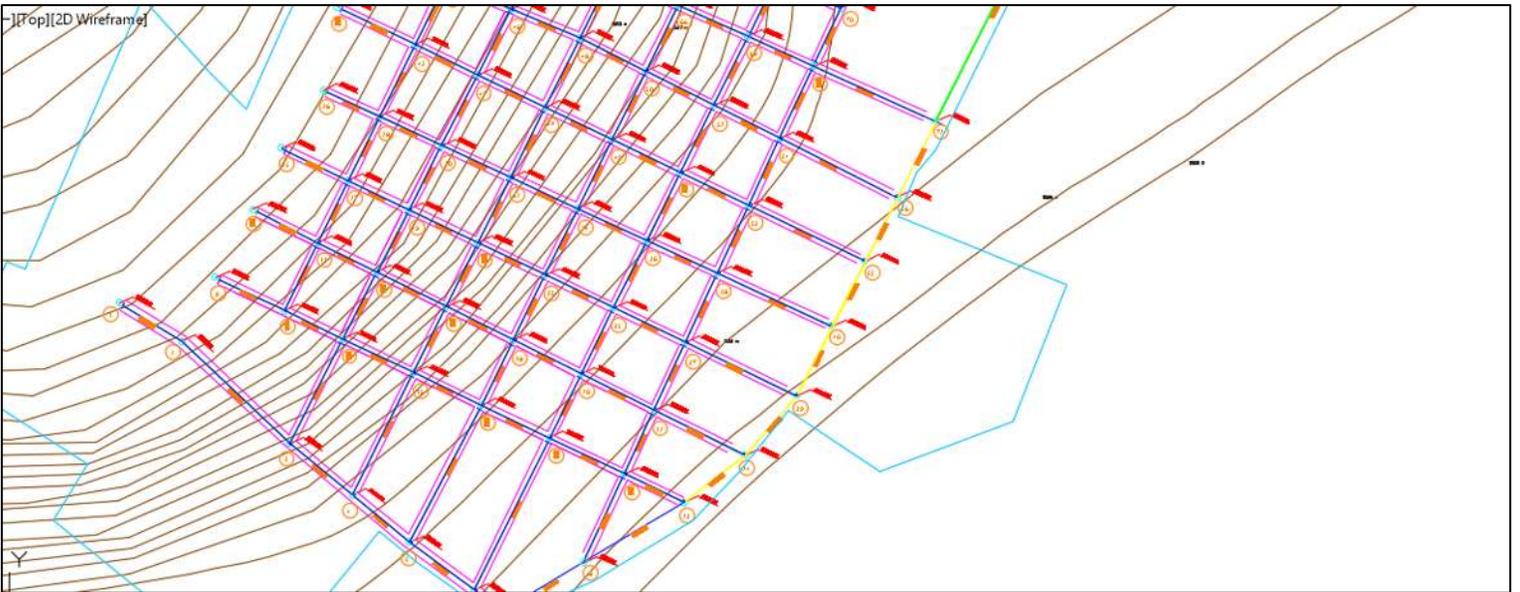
Detalle de elementos del plano topográfico y planeación del sistema.
